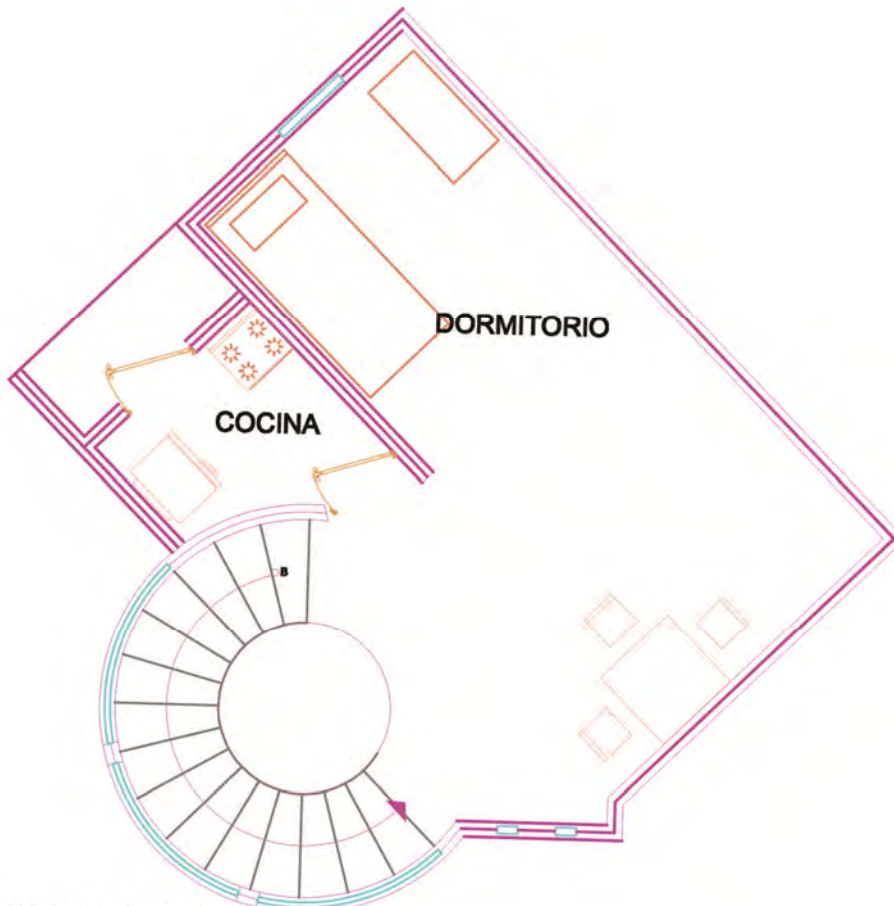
PLANTA ARQUITECTONICA ALTA, SUBESTACIÓN DE BOMBEROS SAN PABLO DEL MONTE, TLAXCALA, MEXICO. (2008)
